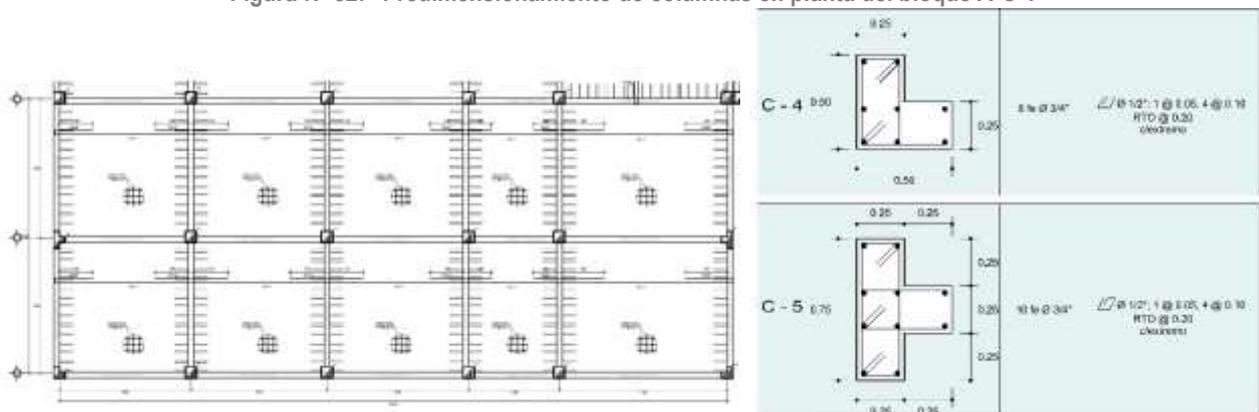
"Predimensionamiento de columnas en planta del bloque A-B-C-D".
